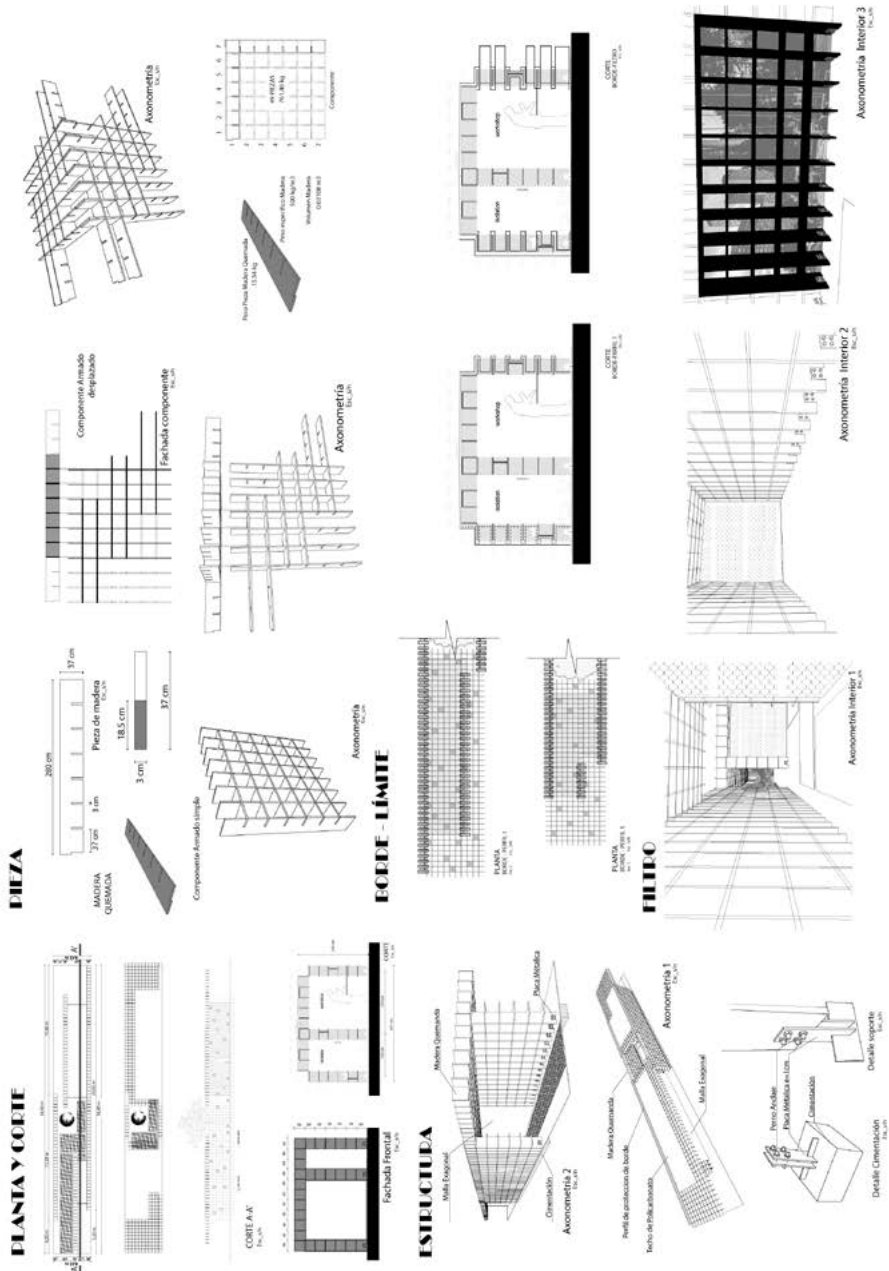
Planos, Estructura, Pieza, Borde – límite, filtro Casa Wabi. Fuente: Elaboración propia.
